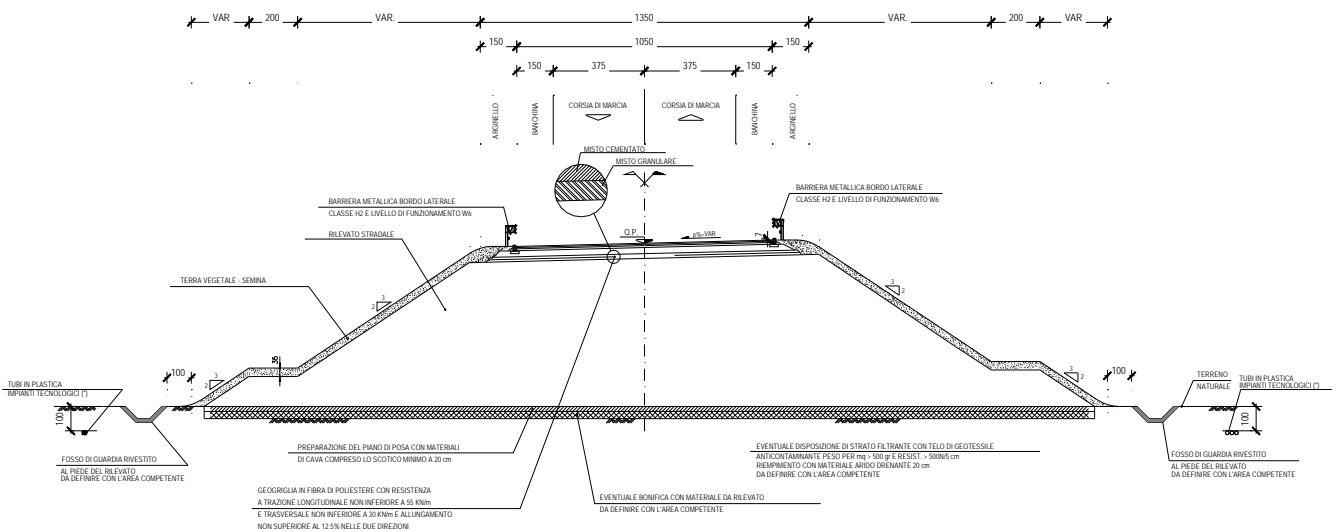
Esempio di sezione di tipo C1 in rilevato.
